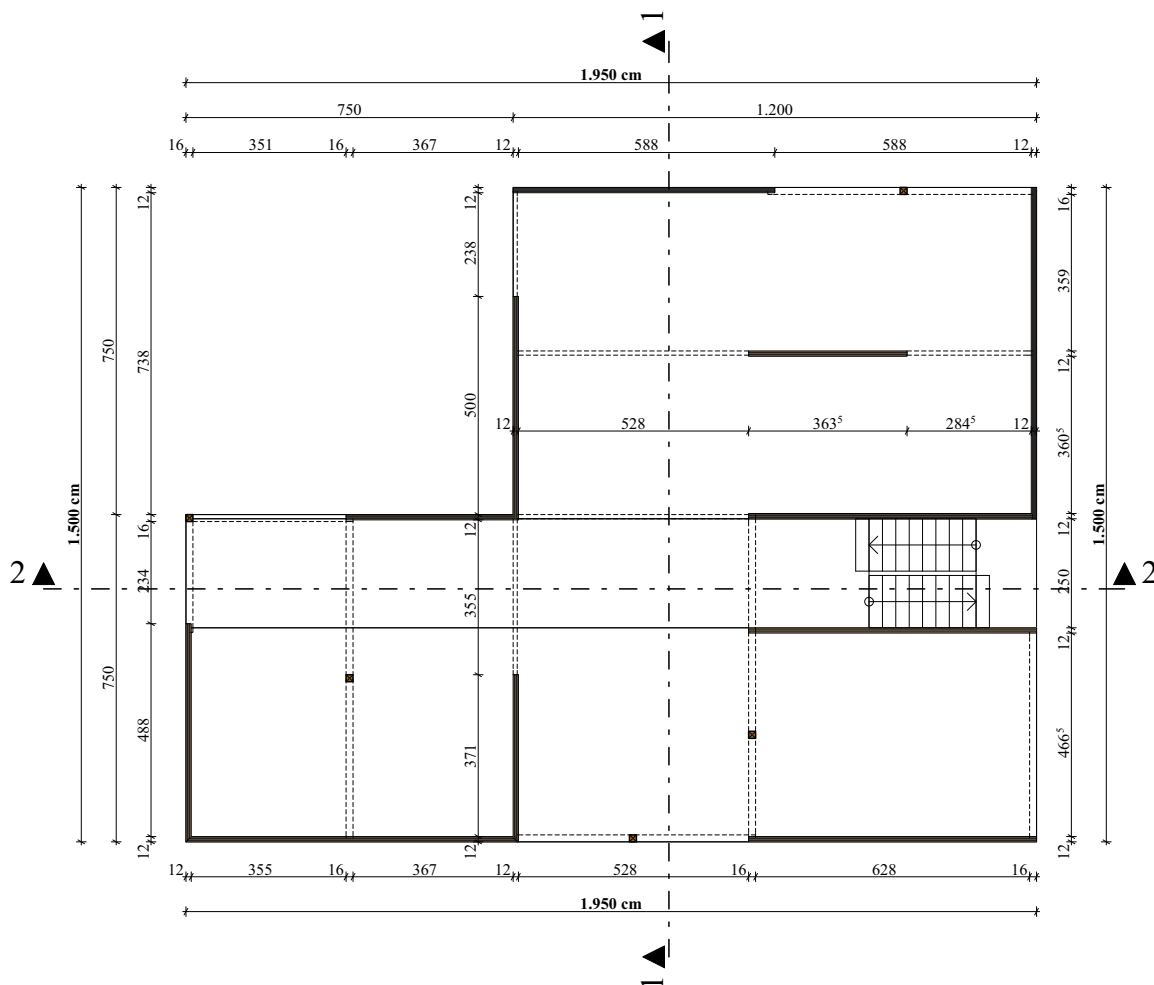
Grundriss des Erdgeschosses des Beispielgebäudes
